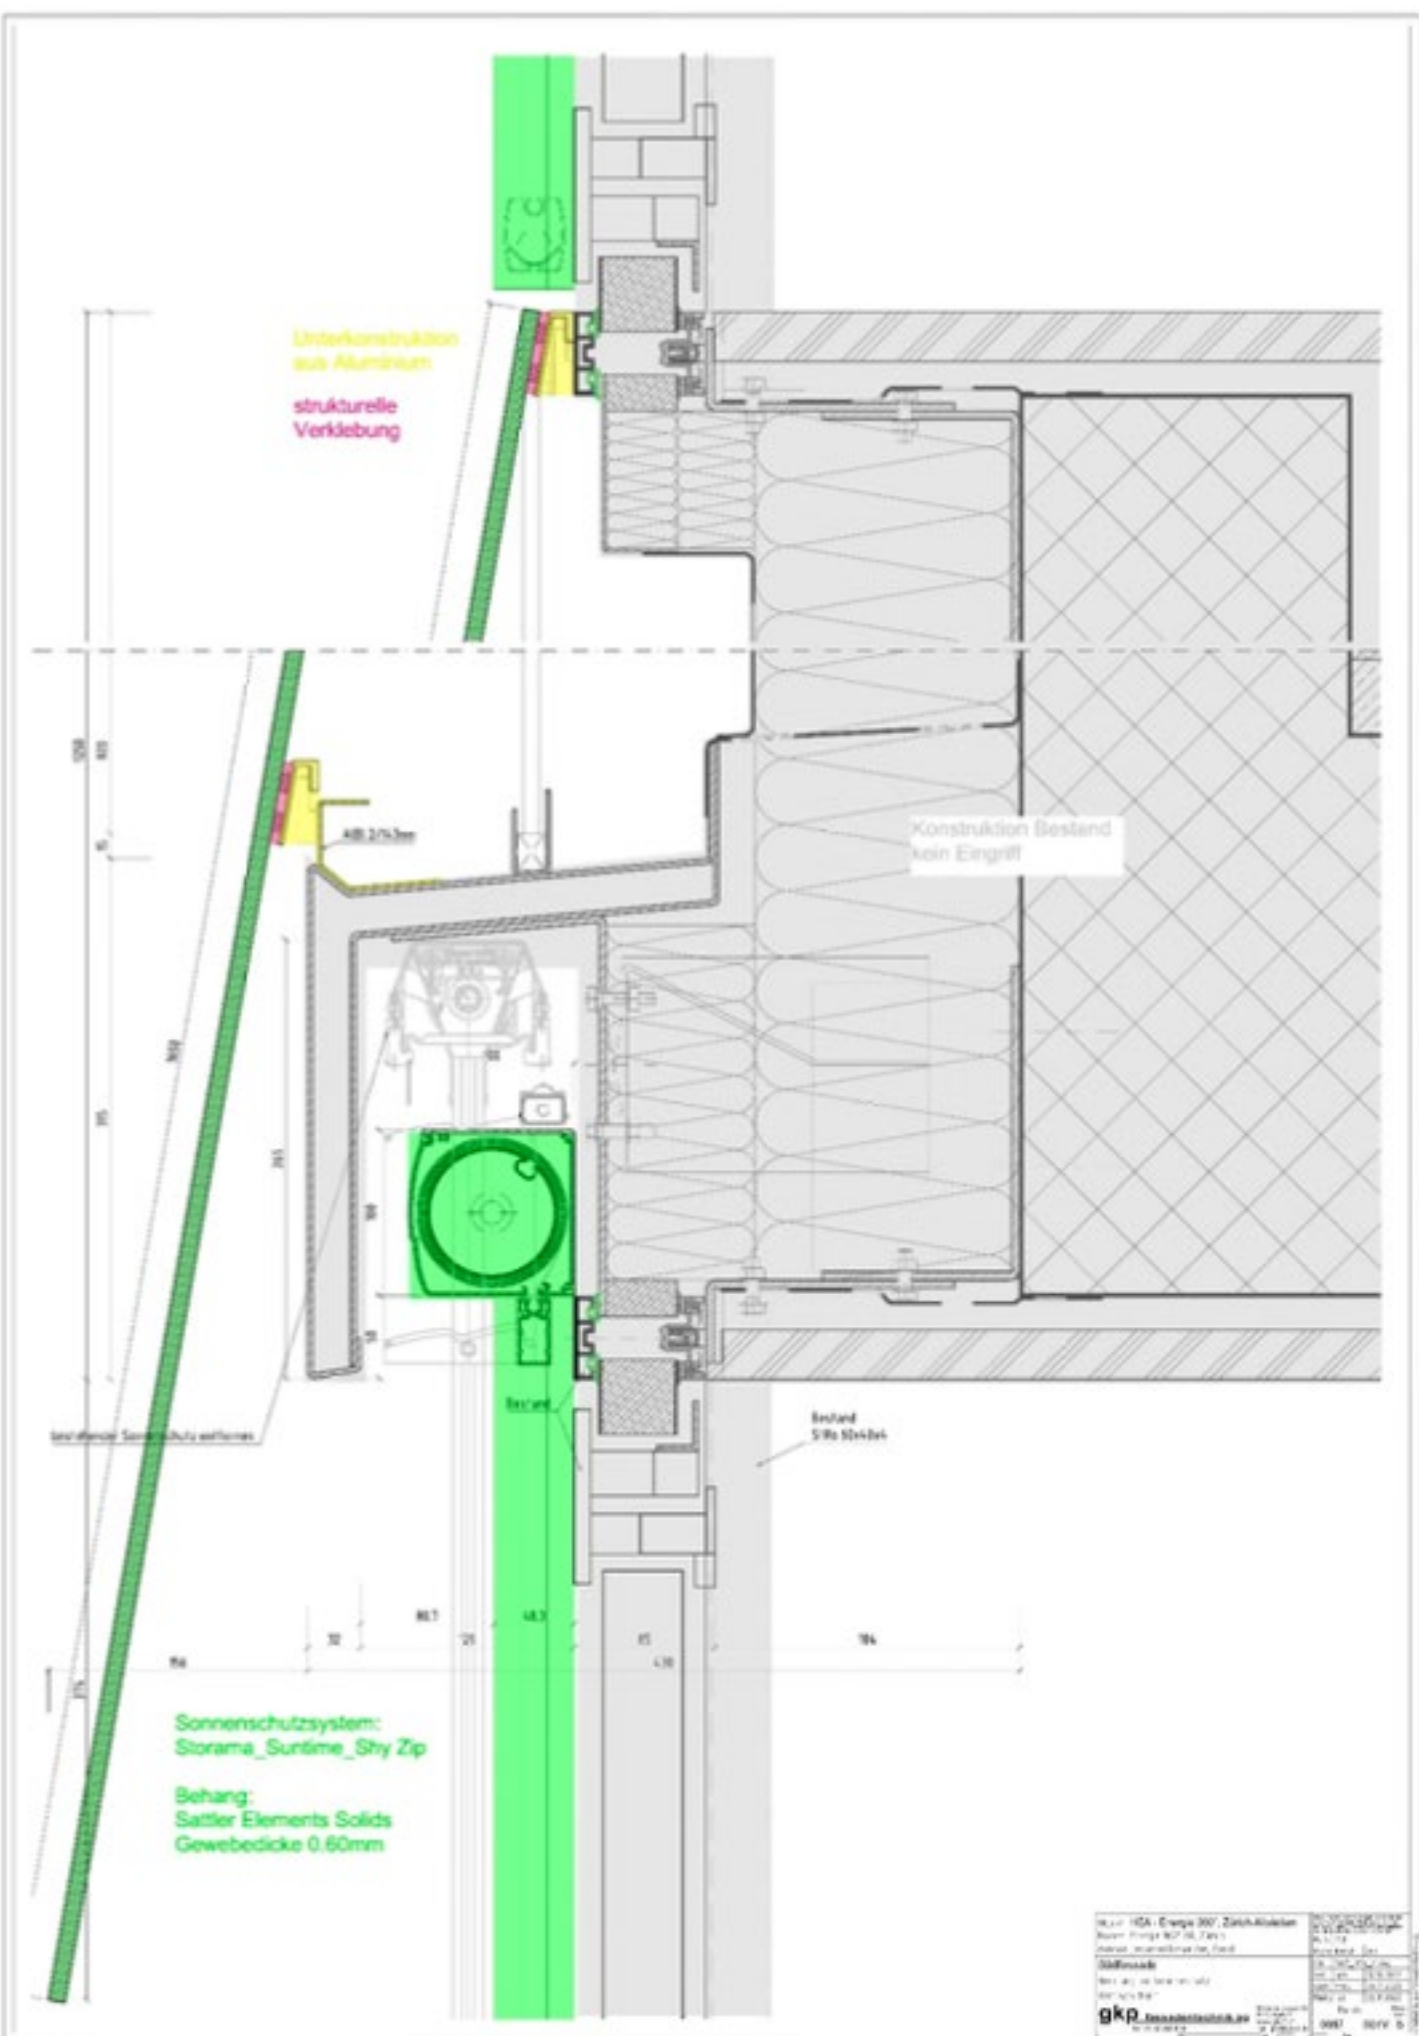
Detailansicht der Konstruktion Südseite des Bauvorhabens: PV-Modul an Brüstung, Bildquelle:[3]
